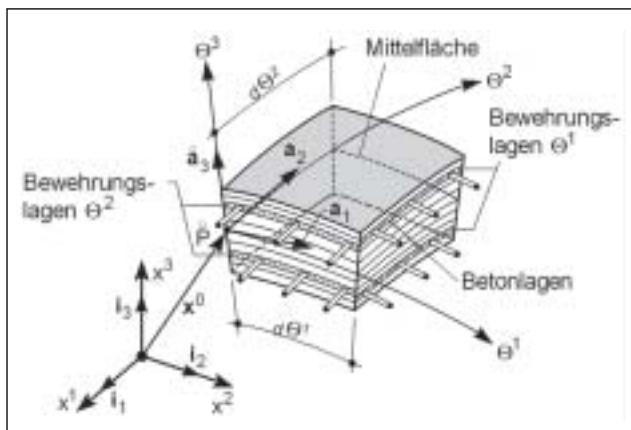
Mehrschichtenmodell einer Stahlbetonschale
